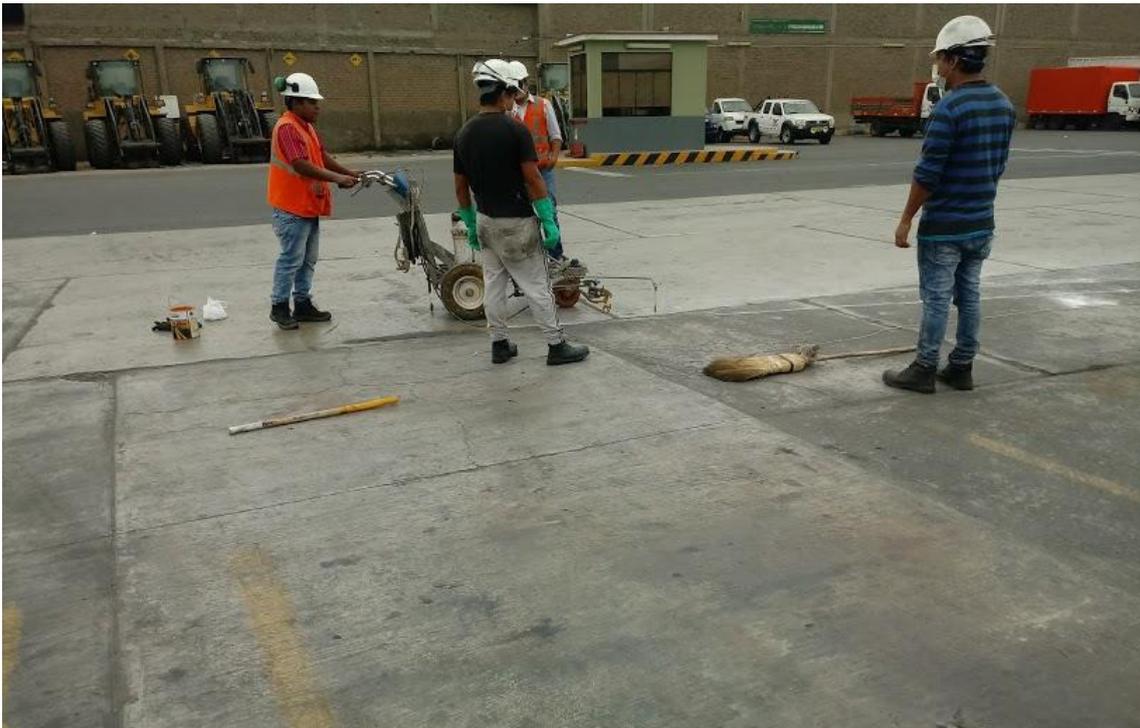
Refacciones con Pintura, Planta TRC SAC – Trujillo.
